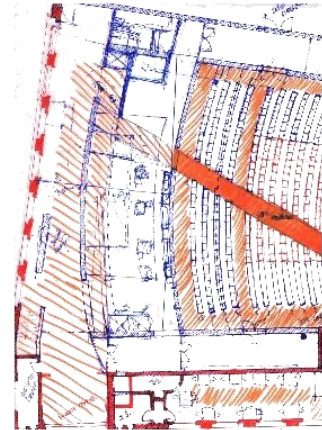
Planta do piso térreo da apropriação para usos.
